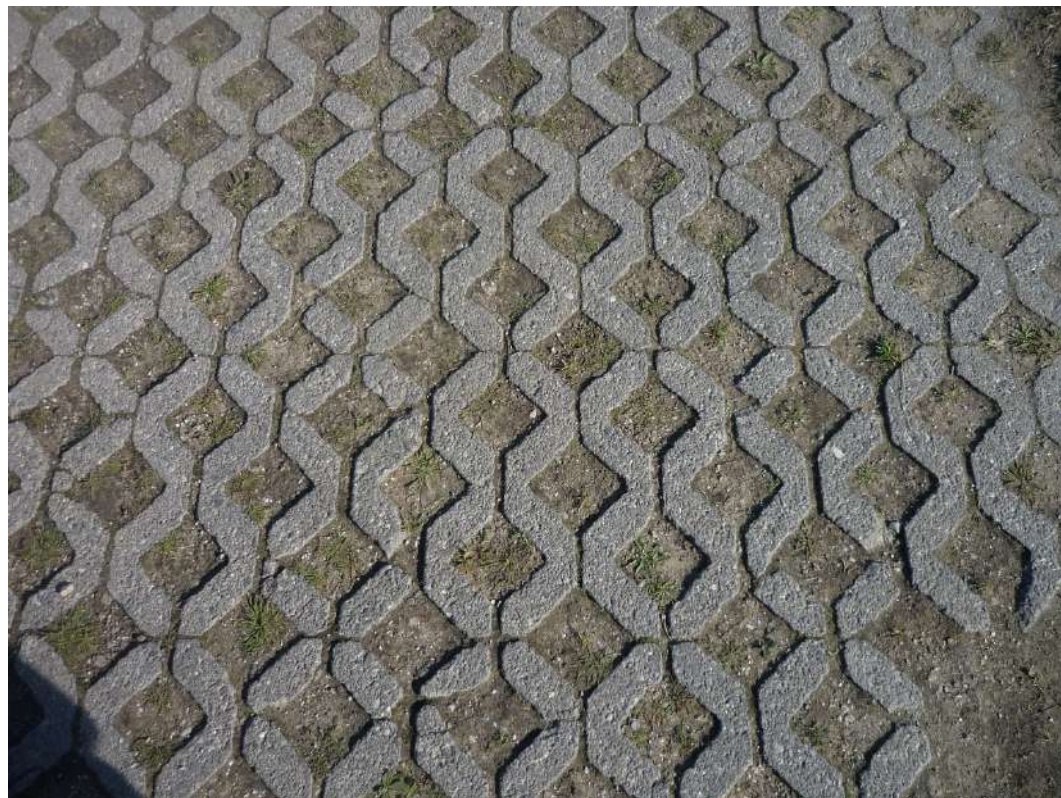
Detalle de la pavimentación del vial al norte del aparcamiento
